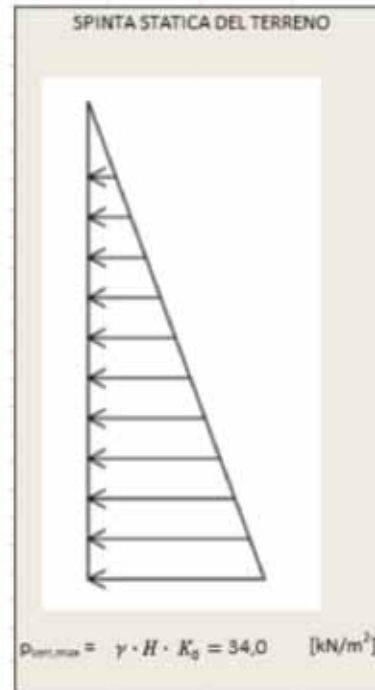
SPALLE A e B – Spinta statica terreno
